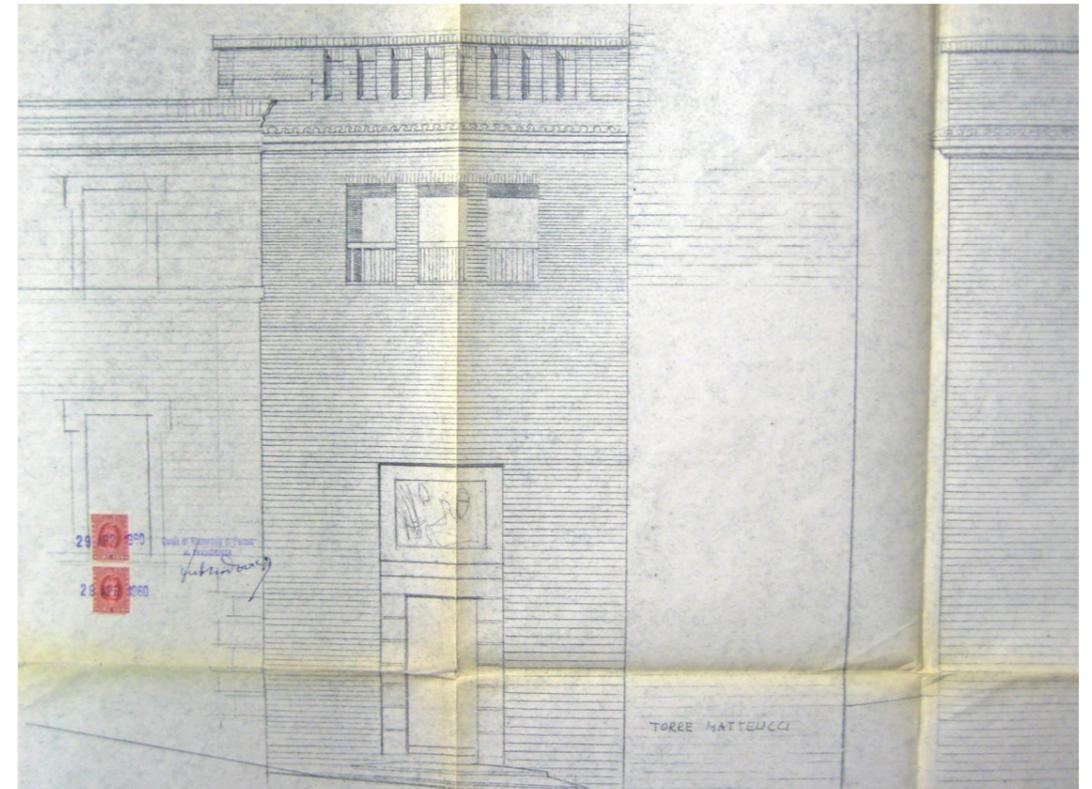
Sopraelevazione del prospetto est. Progetto dell'architetto Tassotti. Archivio di Stato di Fermo.
